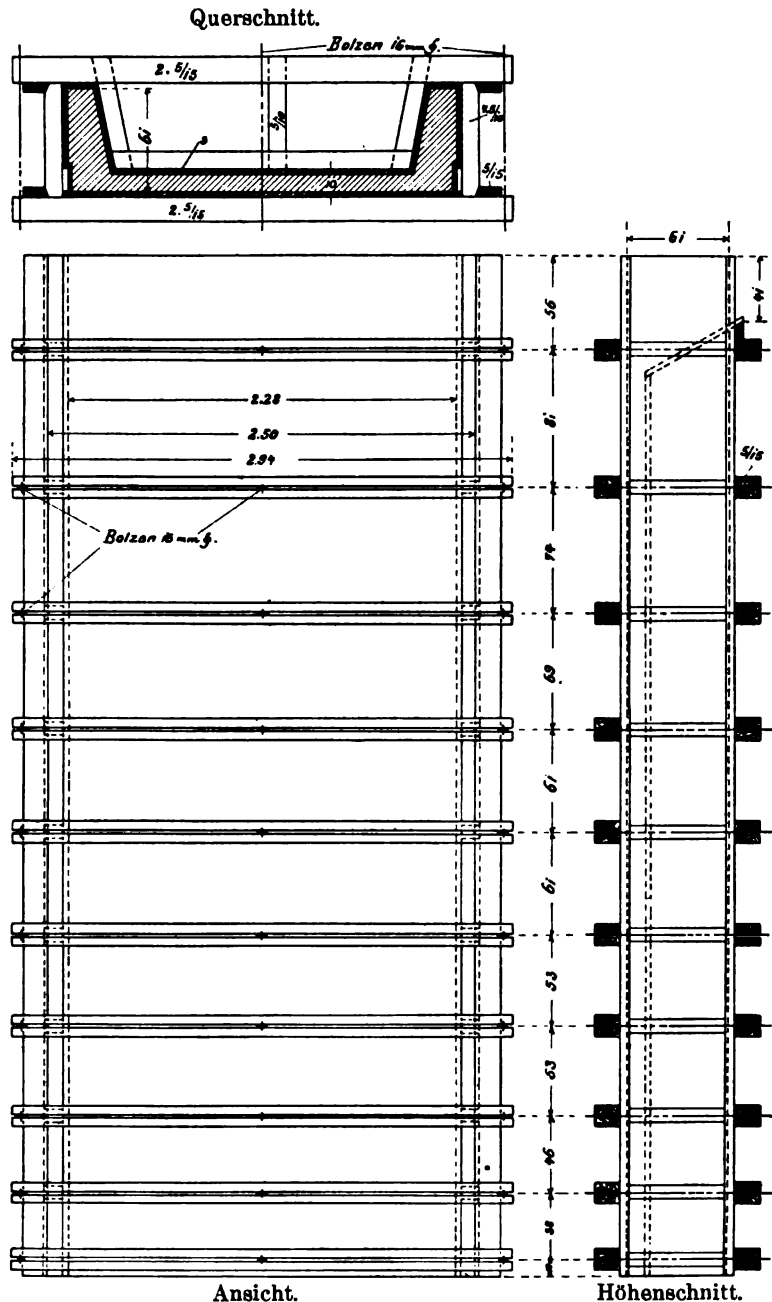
Verschalung der U-förmigen Wandpfeiler des Fabrikgebäudes der Ransome Concrete Machinery Co. in Plainfield, Staat New-York.
